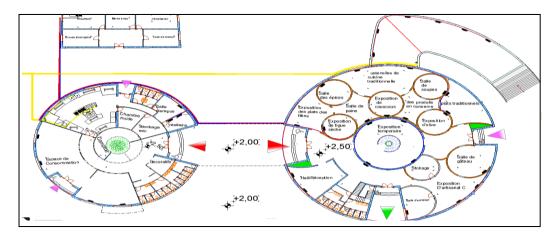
installation de chauffage centrale de notre projet, (source : l'auteur)
